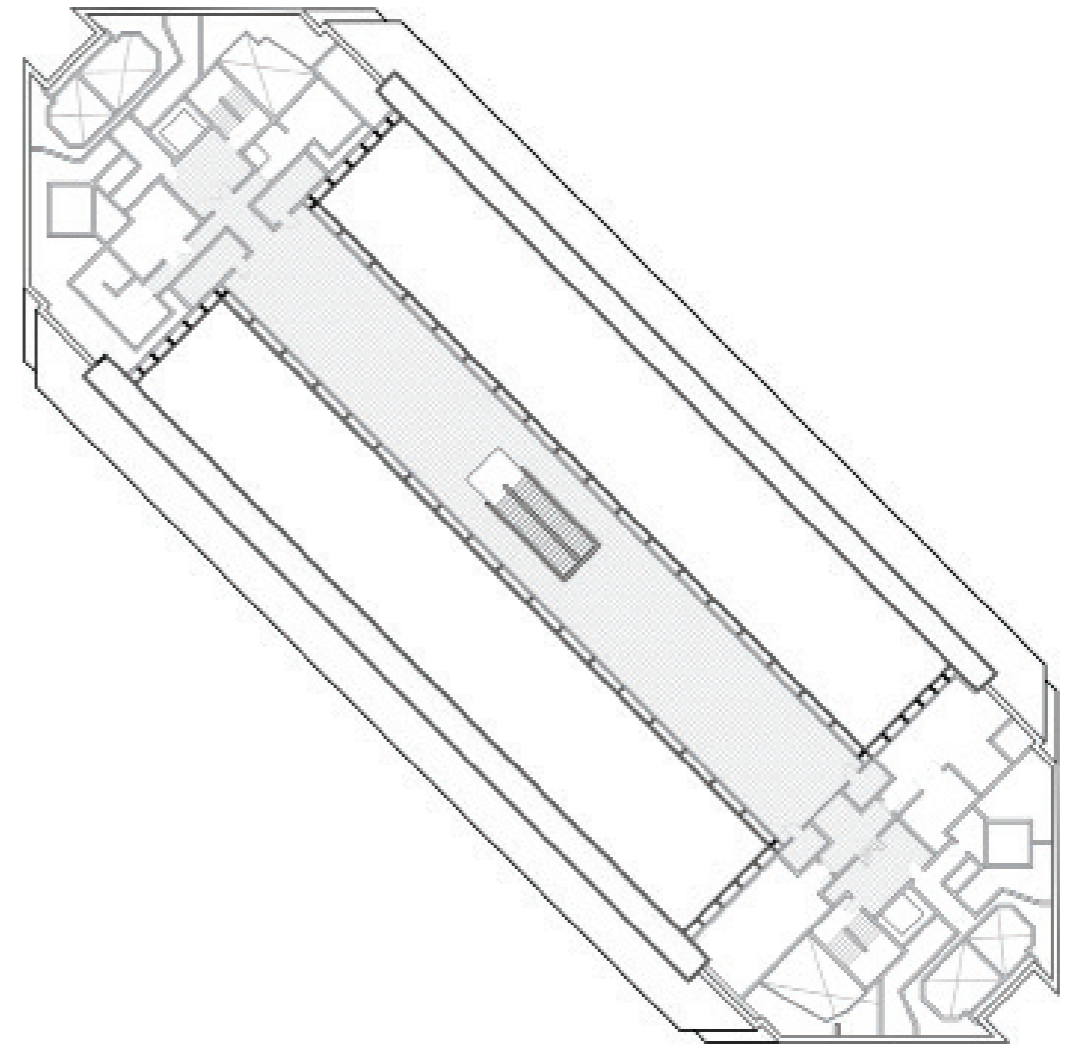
Planta piso 94 Observatorio. Planta realizada por el autor basados en los dibujos del edificio.
